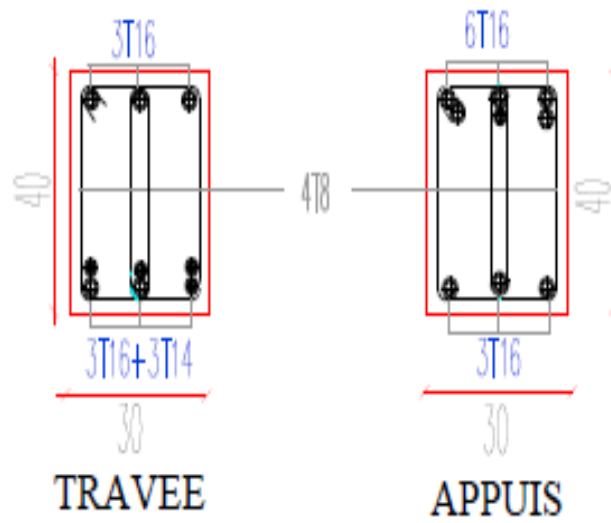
Schéma de ferrailage des poutres secondaire d'étage courant.
